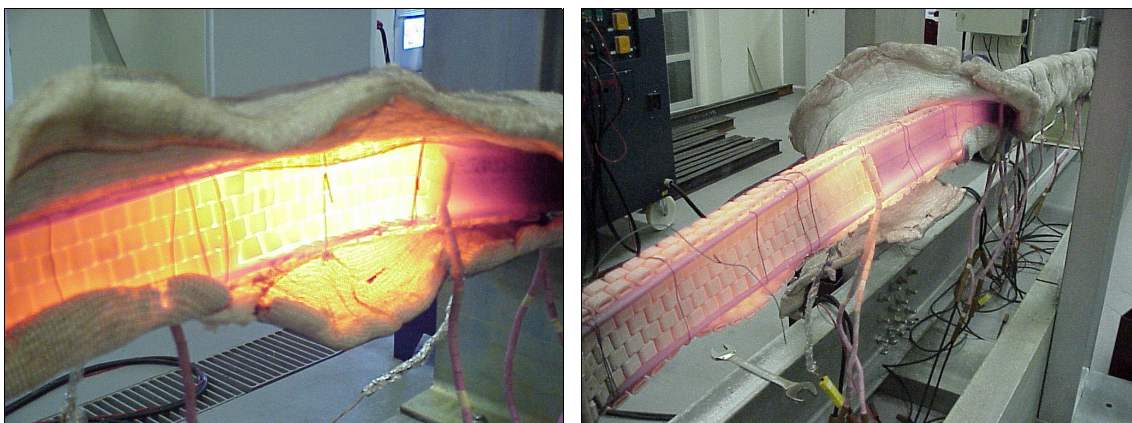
Ensaio de vigas a 600 [°C].
